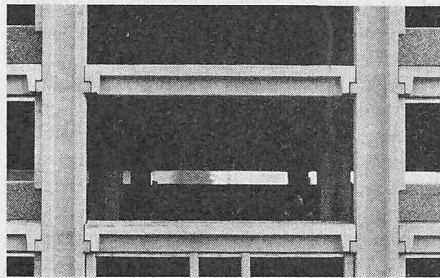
(r.). Fertiges Fassadenelement. Beispiel: Swissair-Zentralmagazingebäude. Normalgeschoss
